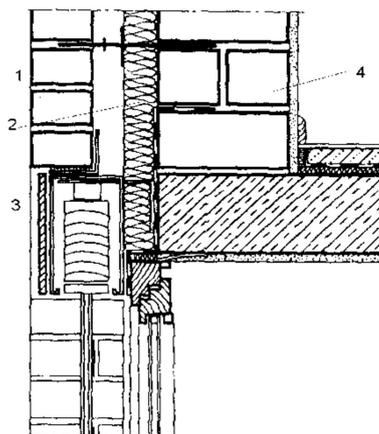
Фрагмент здания с наружными жалюзи:
